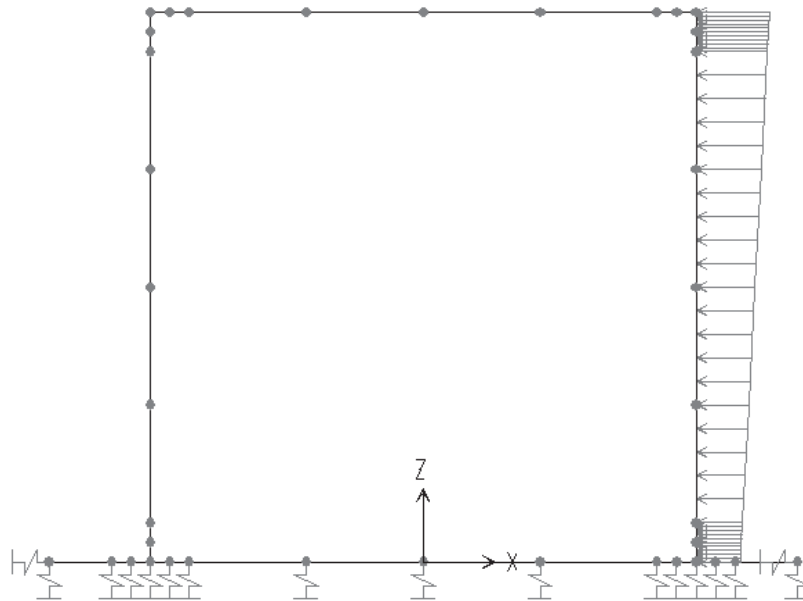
SPINTA DOVUTA DALL'AZIONE VERTICALE DA TRAFFICO SUL PIEDR. DX SQMD
